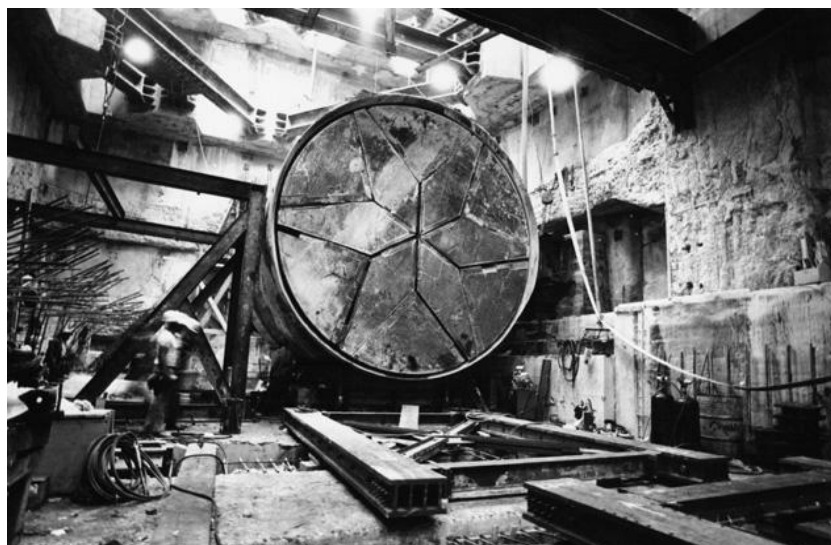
TBM Shield-Bade utilizado para a escavação da Linha 1 do Metrô de São Paulo ( Foto- Metrô-SP)
